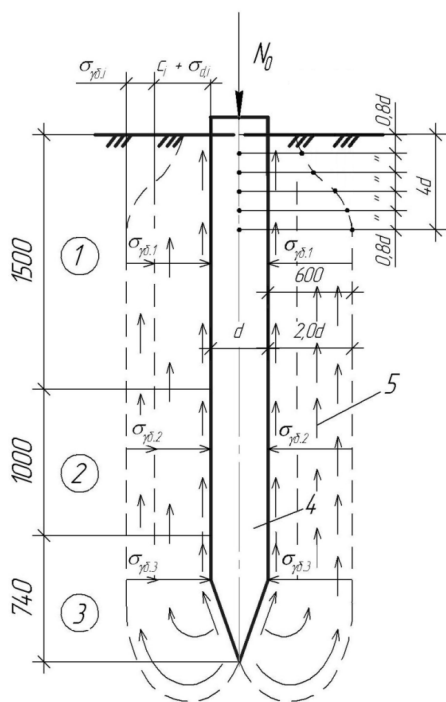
Схема восходящего вверх потока вытесняемого острием набивной взрывофугасной сваи В-2 грунта вдоль ее ствола: 1, 2, 3 – слои грунта; 4 – свая; 5 – направление восходящего потока вытесняемого грунта
